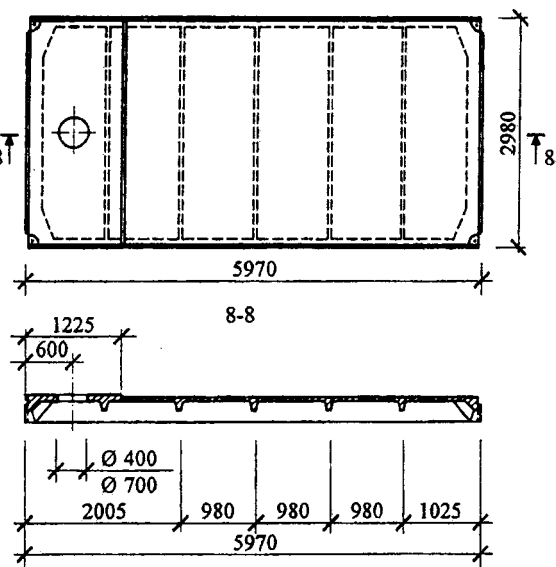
Железобетонные ребристые плиты покрытий пролетом 6 м
